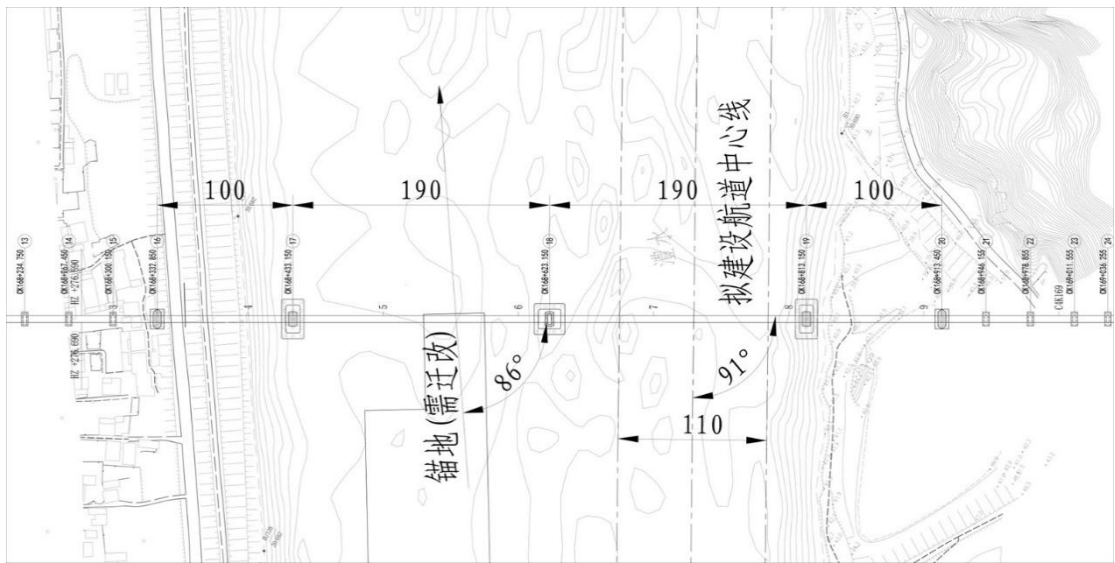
艳洲上游方案跨越澧桥址平面图
